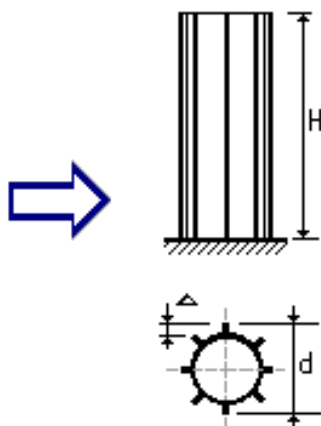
Расчетная схема для ветровой нагрузки
